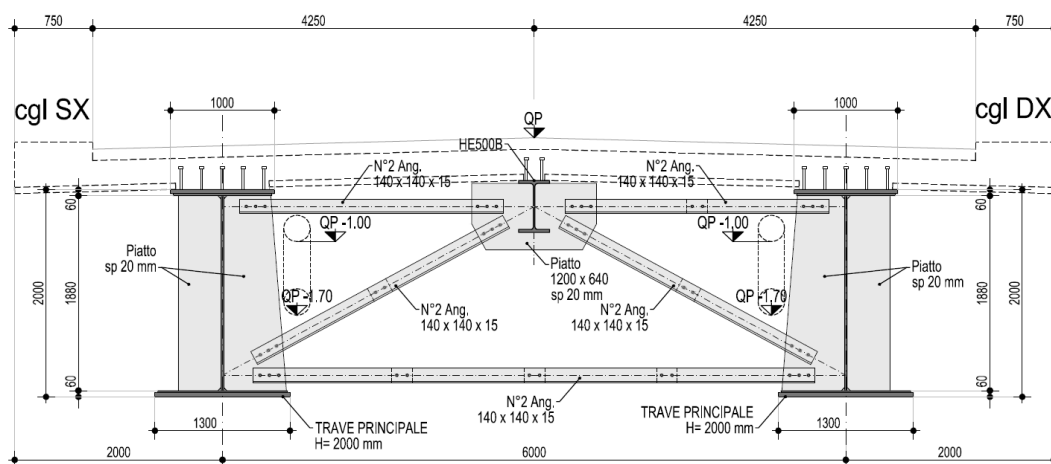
SEZIONE TRASVERSALE IMPALCATO IN CAMPATA 1
